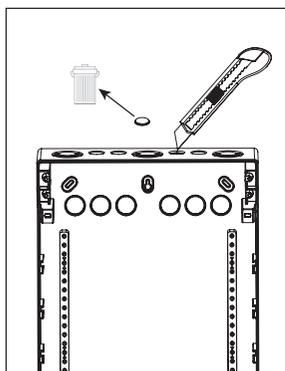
Демонтаж крышки перед установкой шкафа на стену
